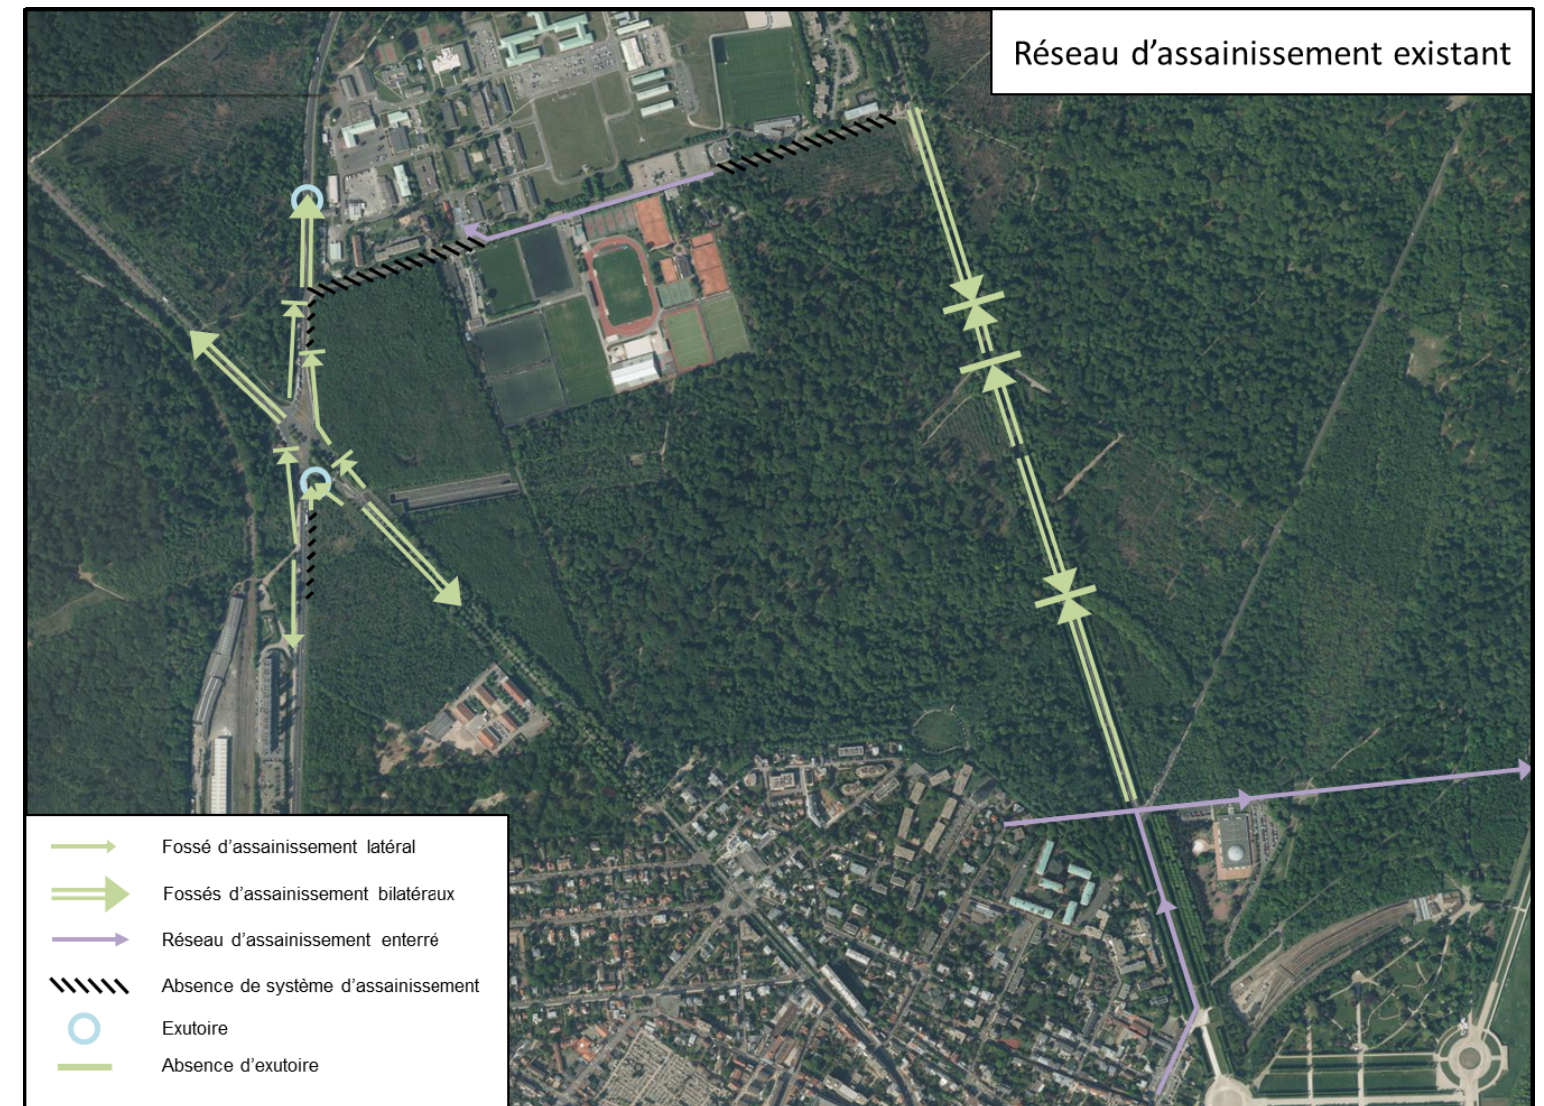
Assainissement existant au droit de la section urbaine de Saint-Germain-en-Laye
